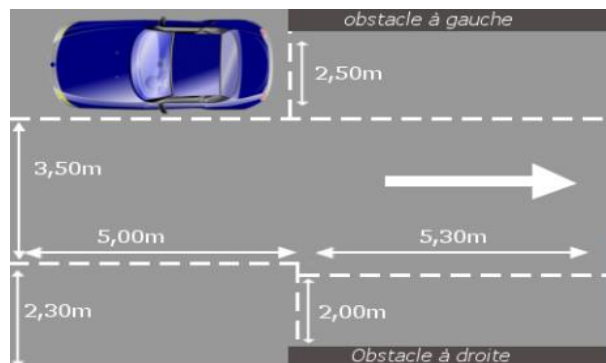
Dimension places de stationnement longitudinales ou stationnement créneau
